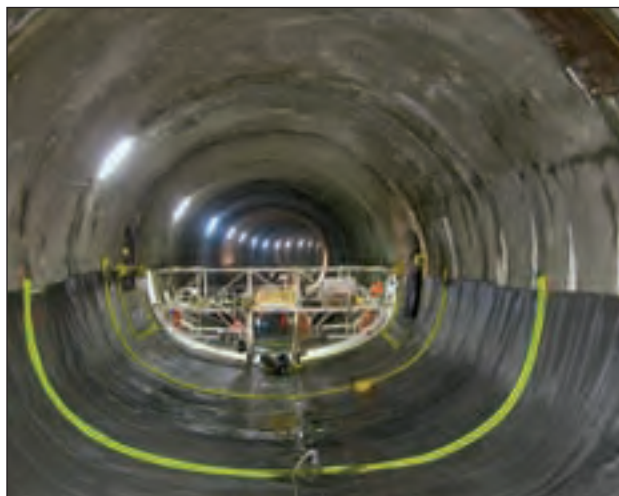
Membrana de protección en solera y cintas flexibles de PVC
